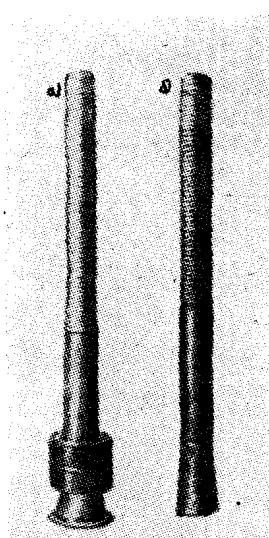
钢筋混凝土科学研究院设计的楔式锚固螺栓构件
